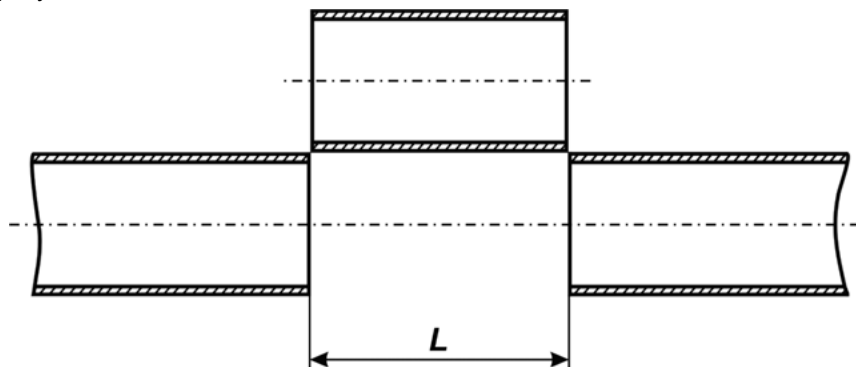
Врезка в трубопровод при установке расходомера
